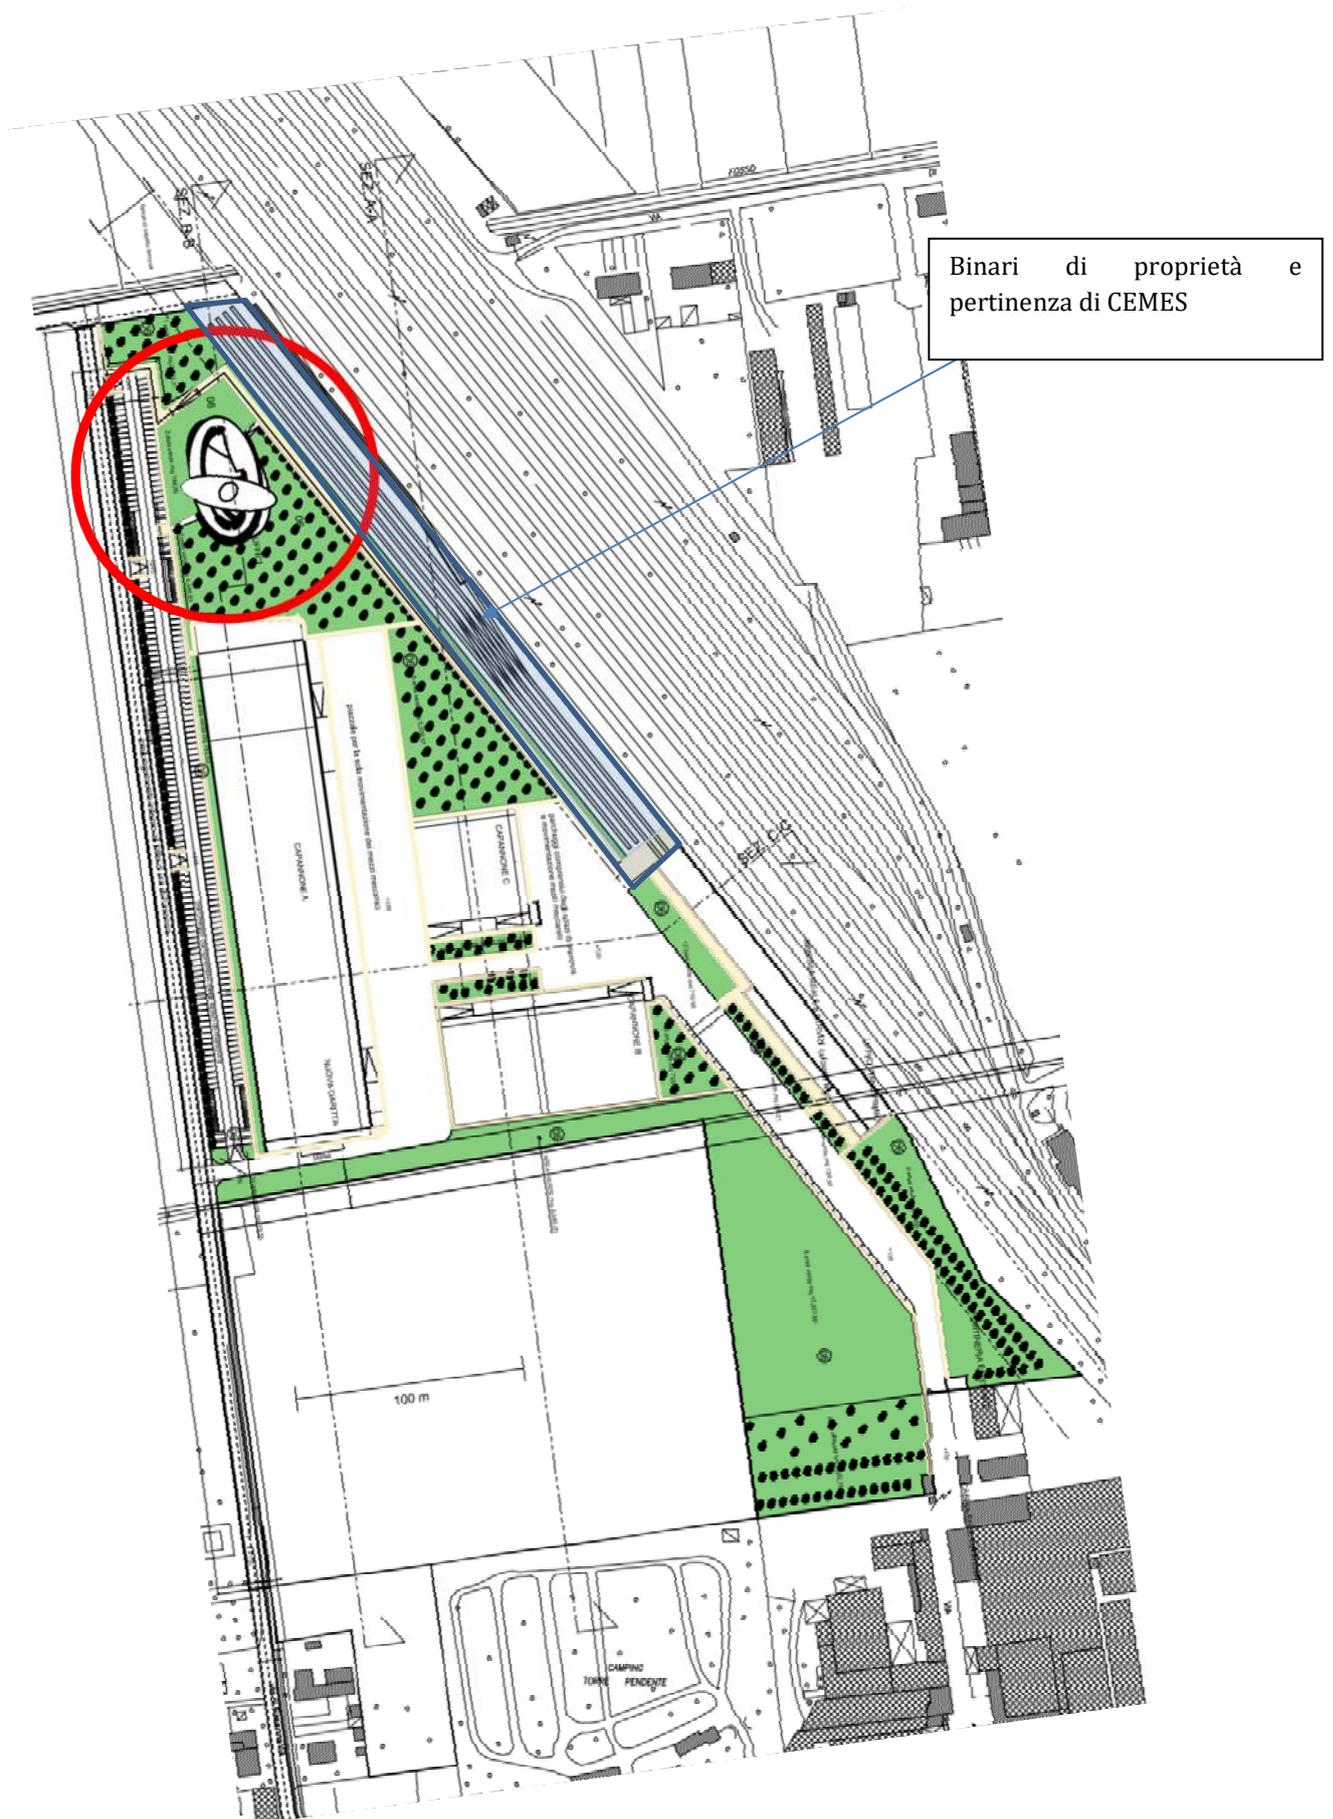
Planimetria generale dell'intervento con individuazione della posizione e della forma dell'edificio (entro il cerchio rosso)
